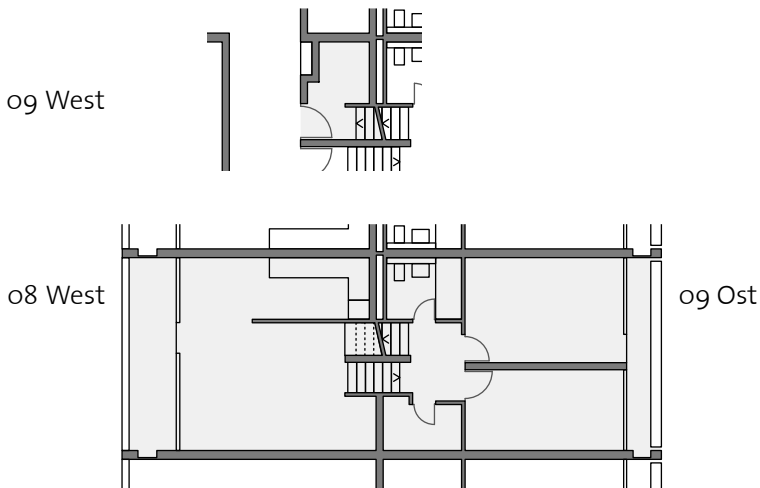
Typengrundriss 3-Zimmermaisonette
